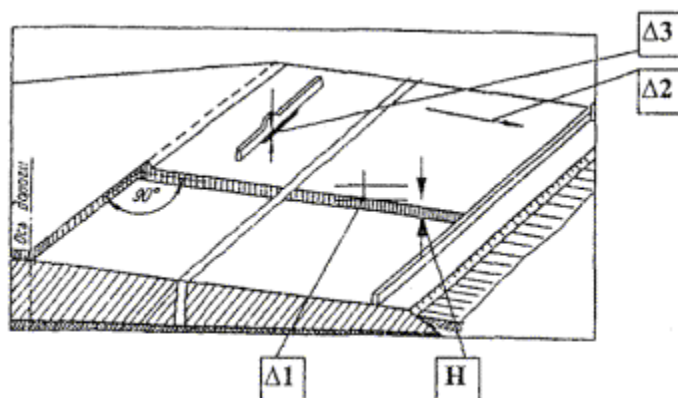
Н — толщина уплотненного слоя; В — ширина основания (покрытия)
